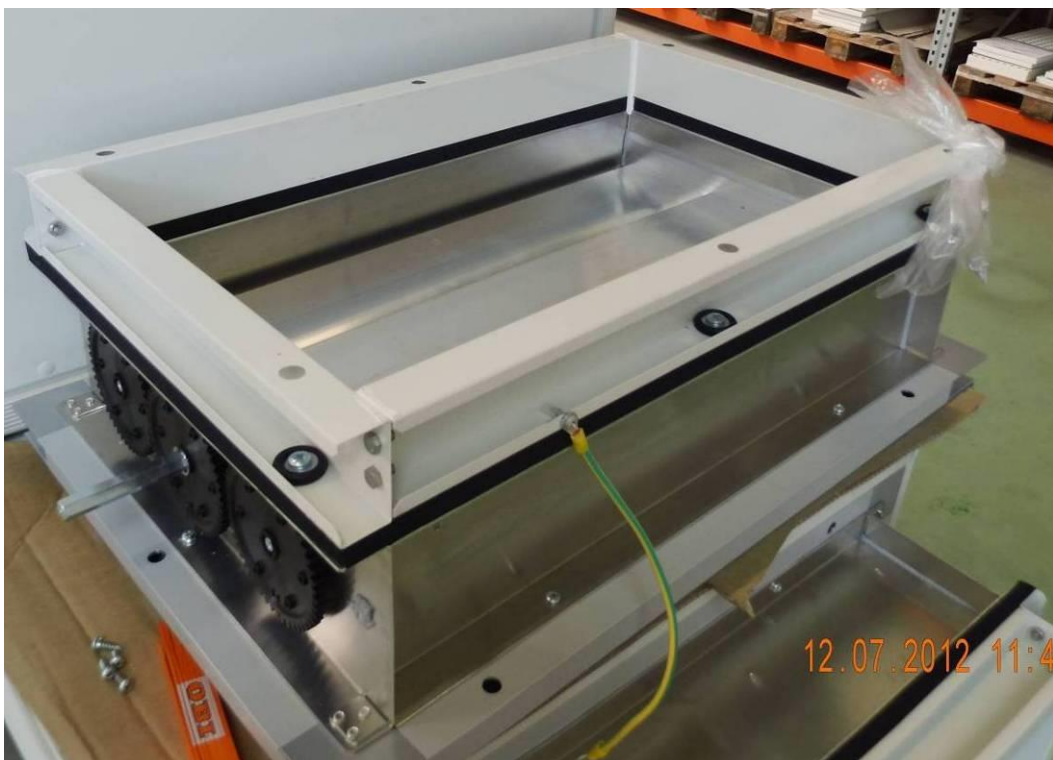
Luftleitungsanschluss mit Jalousieklappe Außenluft (demontiert)
